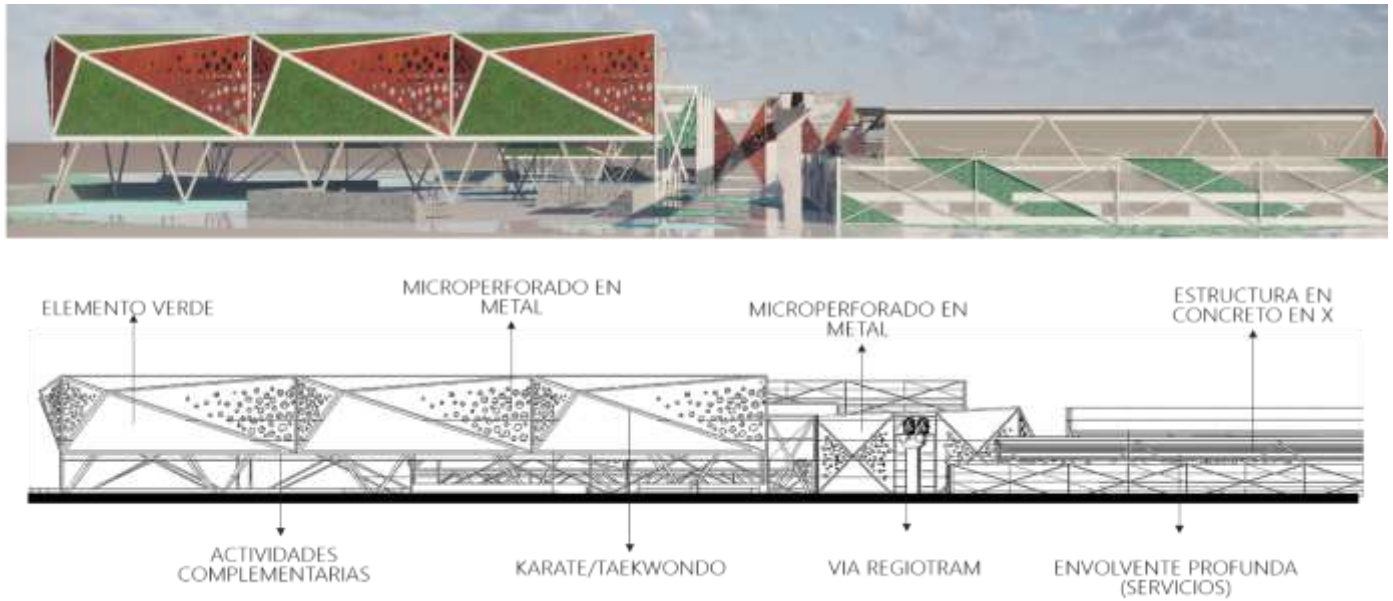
Fachada posterior. (Fachada micro perforada y muro verde). Autoría propia.
